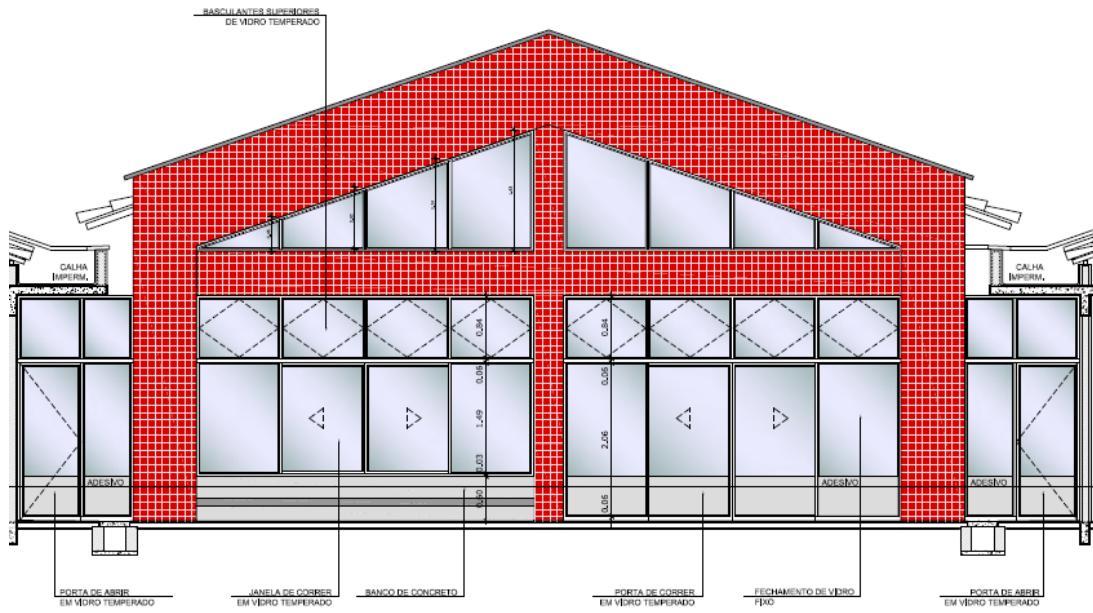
vista do fechamento do pátio coberto da escola infantil tipo B.
